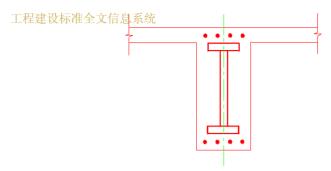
型钢混凝土梁的型钢截面配筋形式
